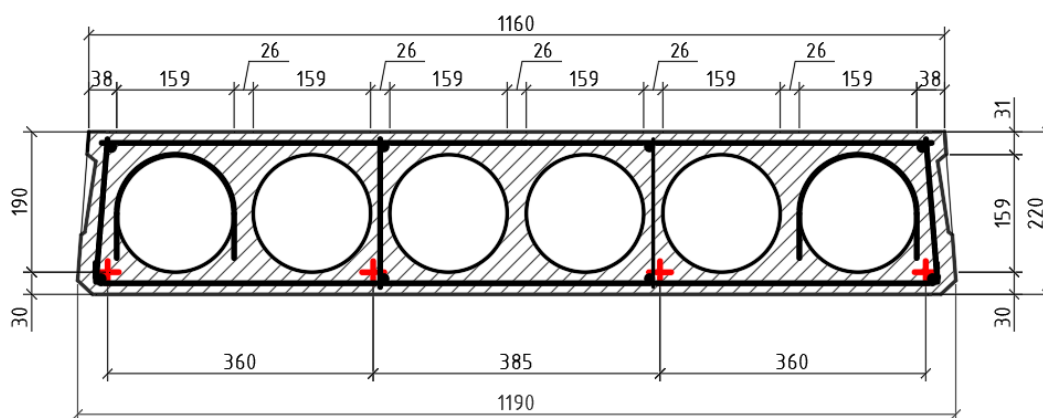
Розміри поперечного перерізу та схема армування плити
